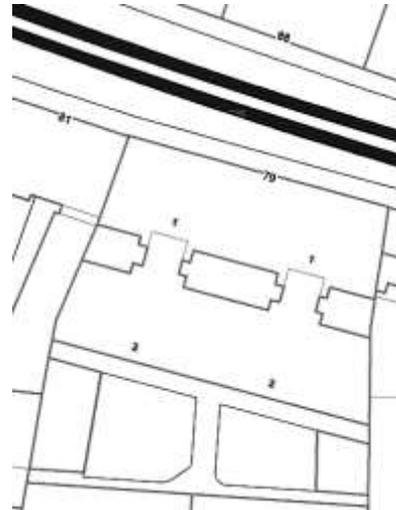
Grundriss Hernalser Hauptstraße 79-79A
